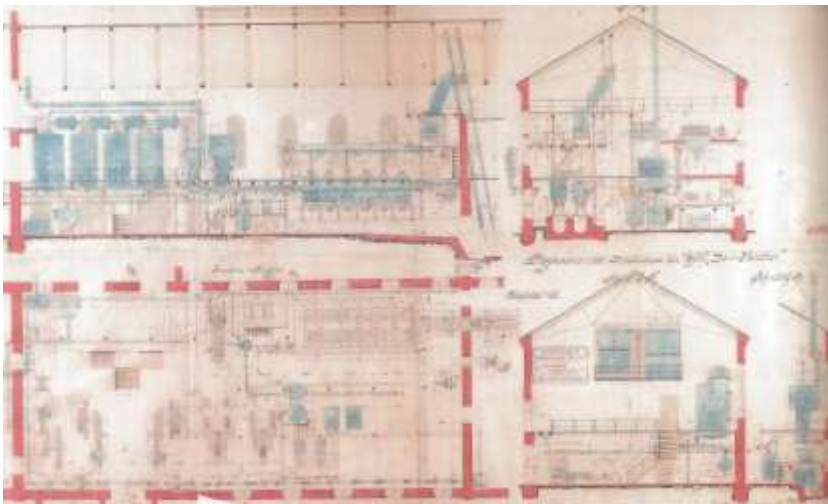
Plano de planta, sección longitudinal y secciones transversales del proyecto original de la Fábrica de San Isidro (1901). Fuente: Colección Privada M. Giménez Yanguas.
